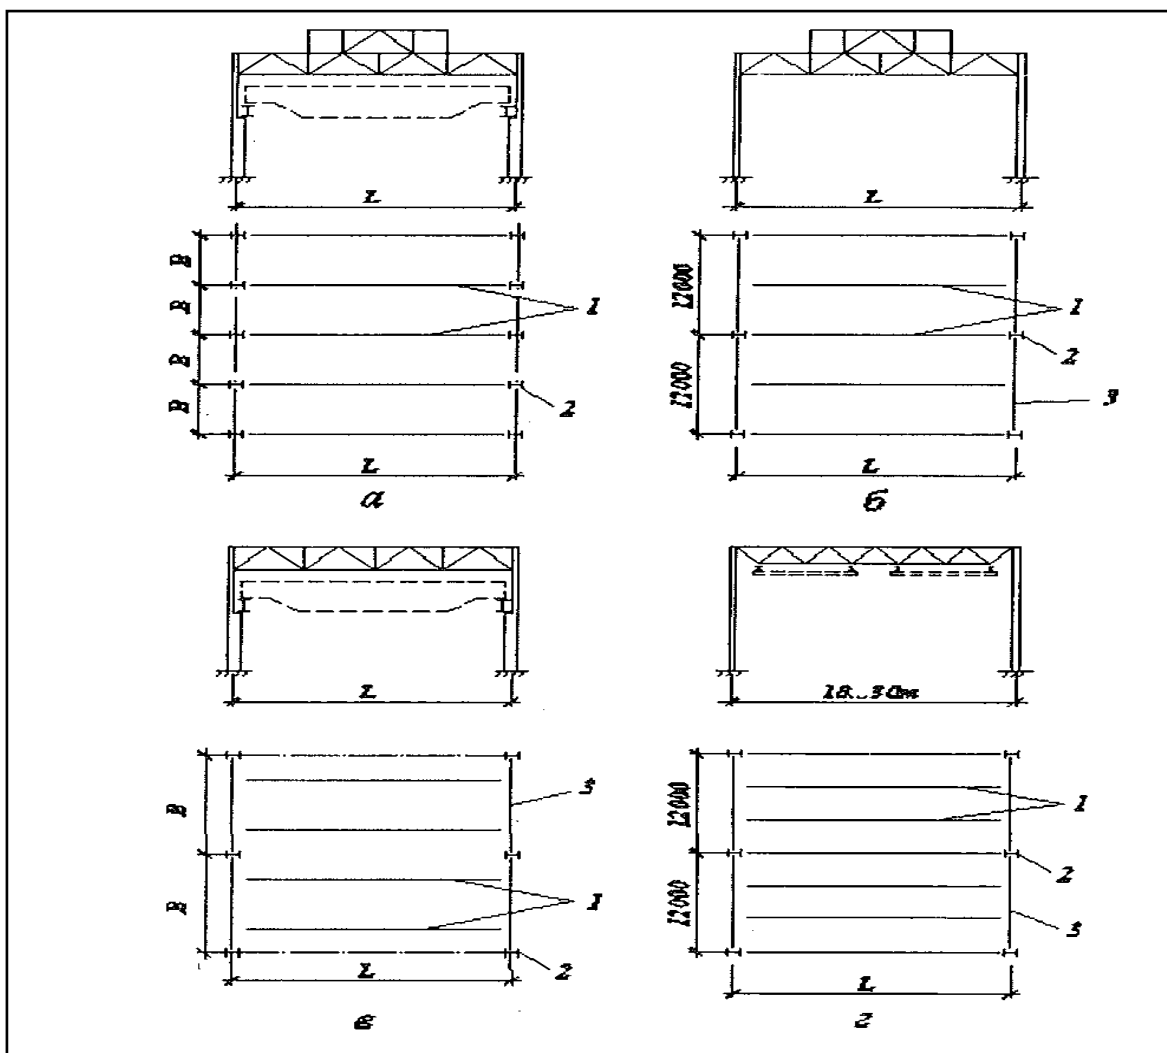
Конструктивні схеми однопролітних каркасів: *a* – крок колон дорівнює кроку ферм; *б, в, г* – крок колон більший за крок ферм; 1 – кроквяні ферми; 2 – колони; 3 – підкроквяні ферми
